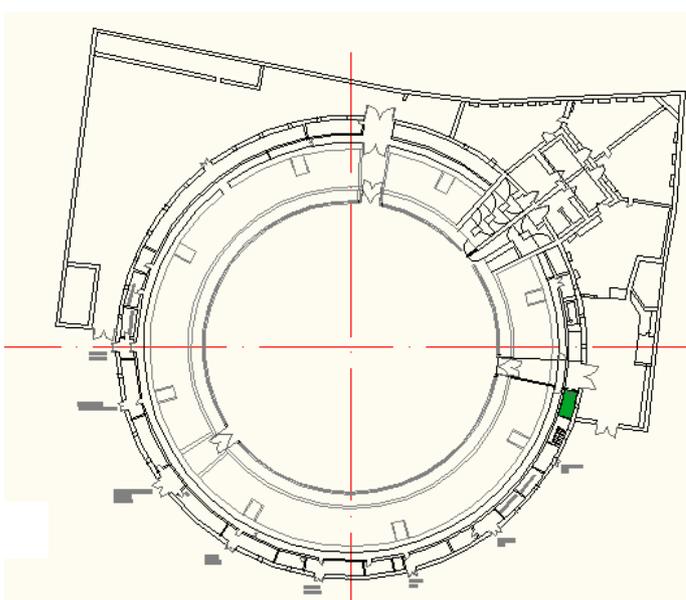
plano de planta calle de la plaza, sala de cuadro general y G.E. destacada en verde.
